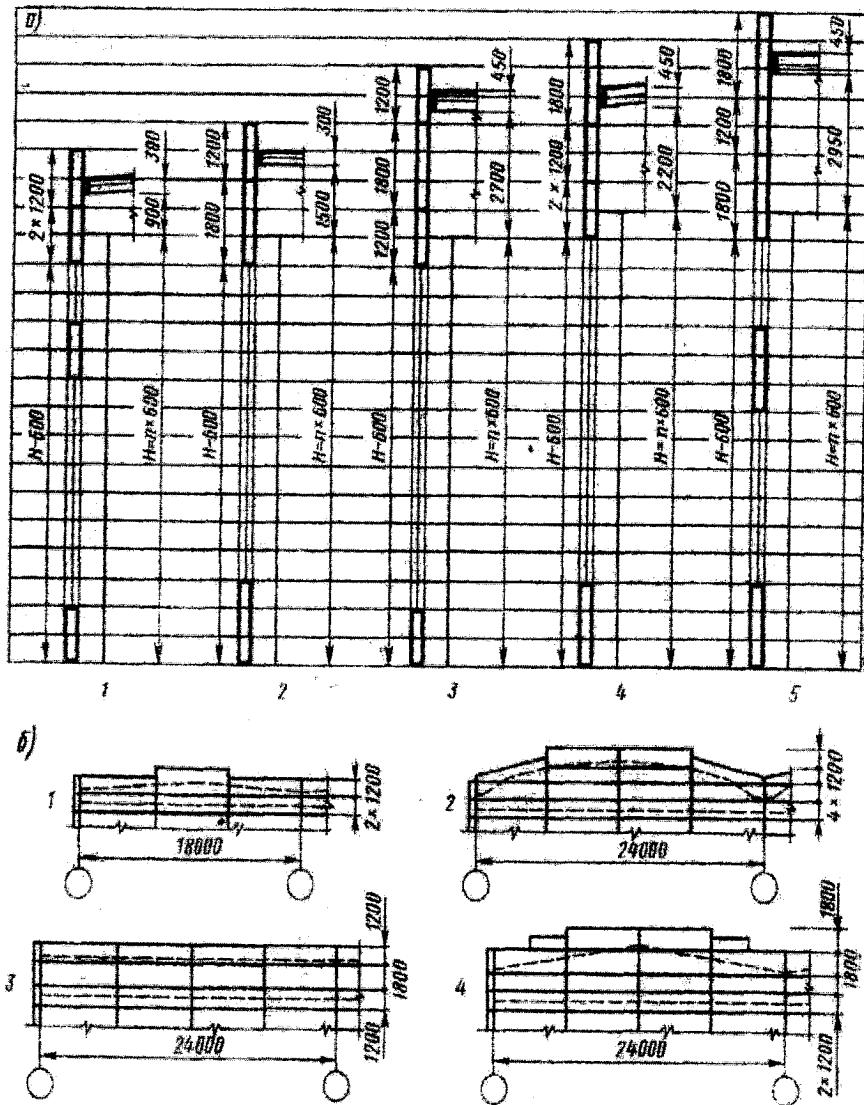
Схема розкладки панелей в стінах одноповерхових будівель:
